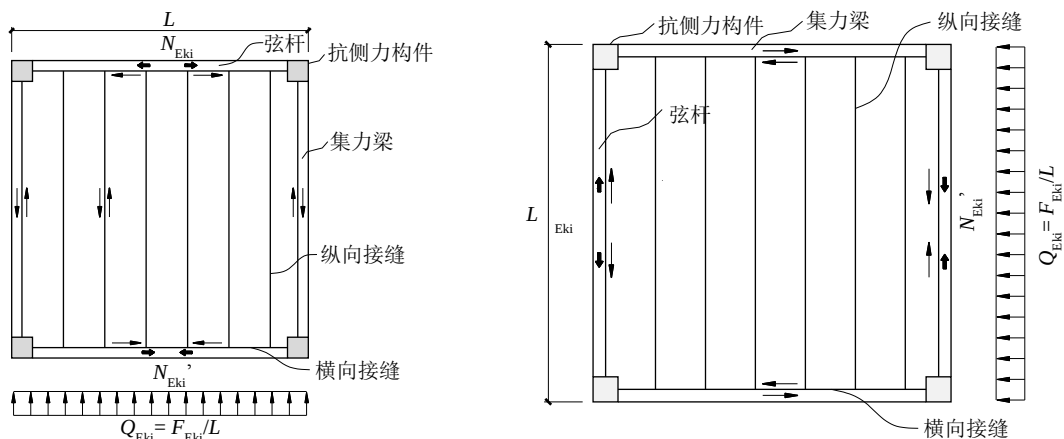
无叠合层预应力混凝土双 T 板楼盖深梁模型
